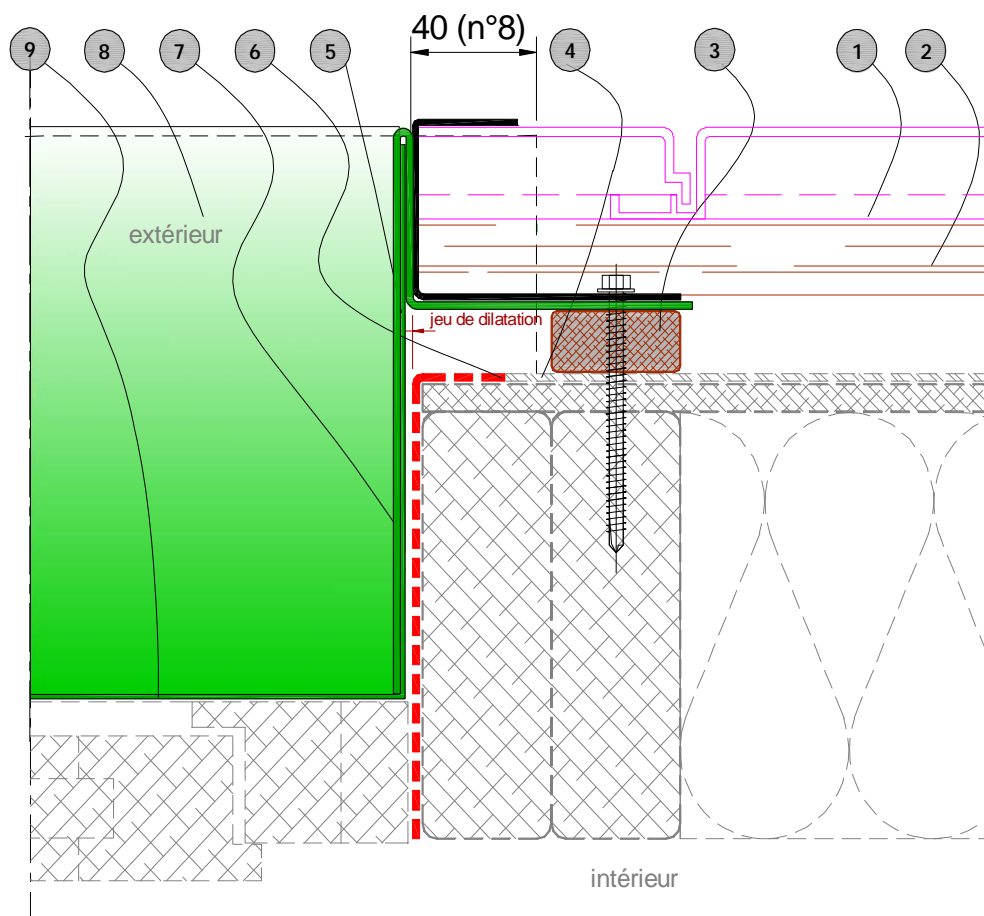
Coupe sur Appui – Tunnel Intérieur
